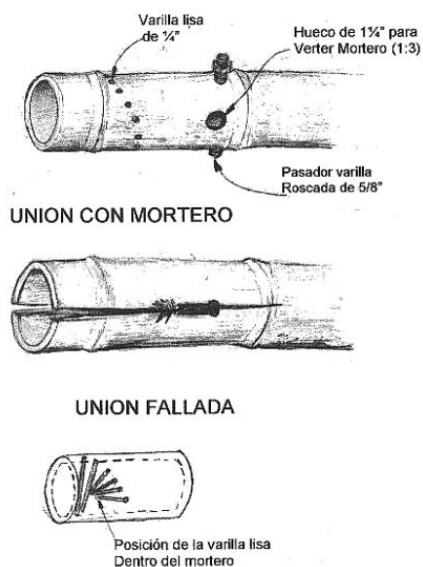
Ligação do grupo 4B com enchimento de argamassa - (cit. CHEATLE, L.F.L.M.a.D.T., 2002)
